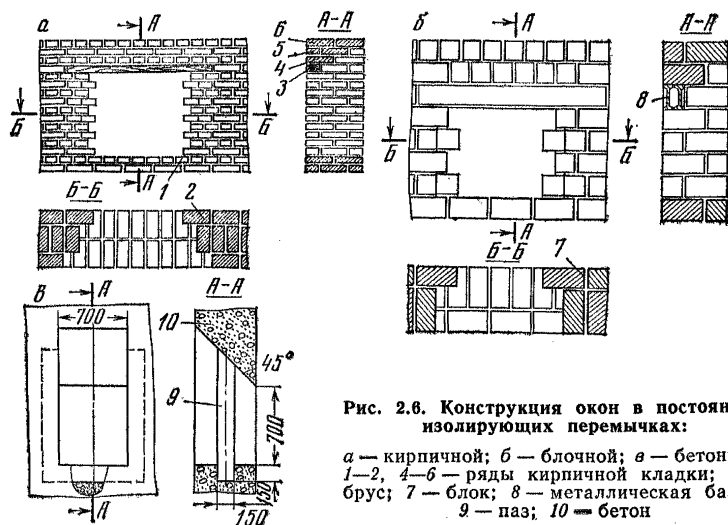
Конструкция окон в постоянных изолирующих перемычках:
